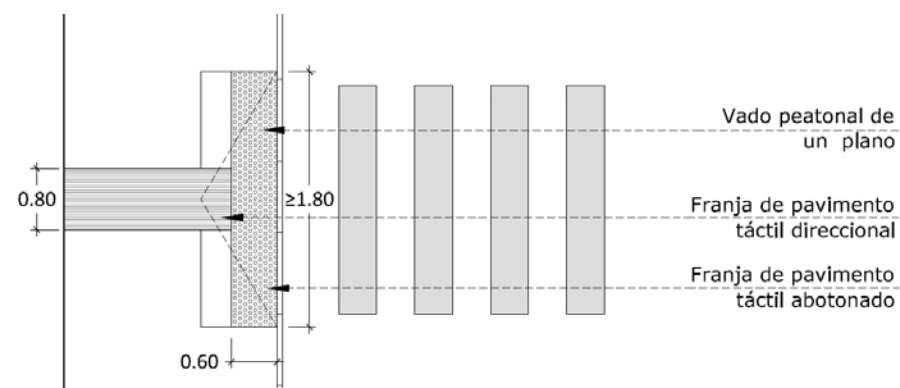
Imagen de pavimento indicadores en vados. Fuente: Fichas de SINPROMI
